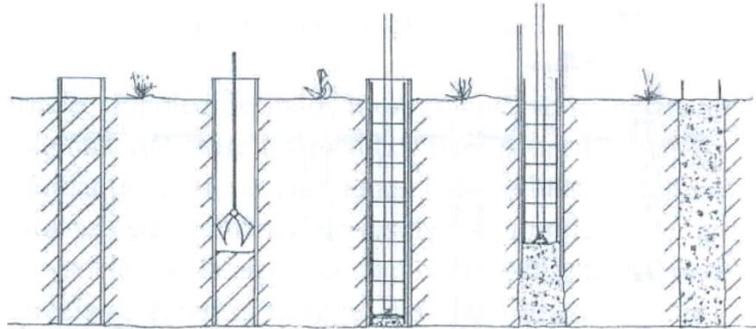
Ejecución de Pilote con camisa metálica recuperable.
